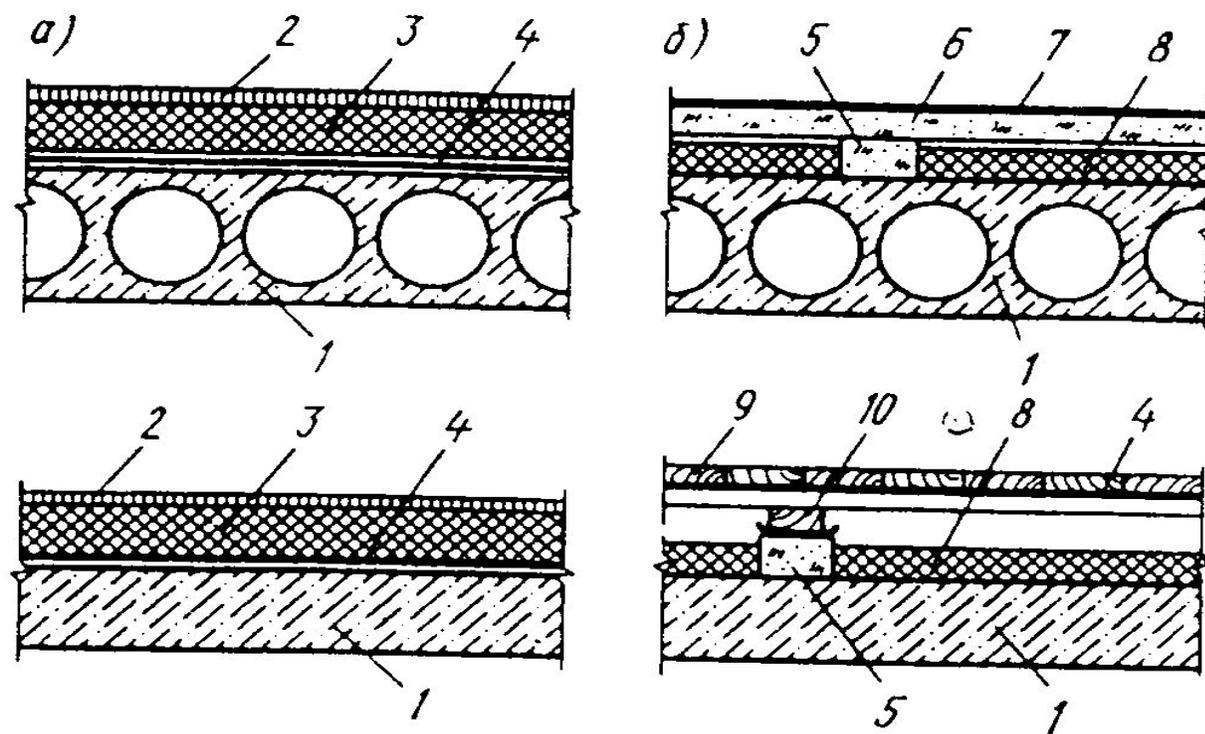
Перекрытия над подвалами, проездами и чердачные:
